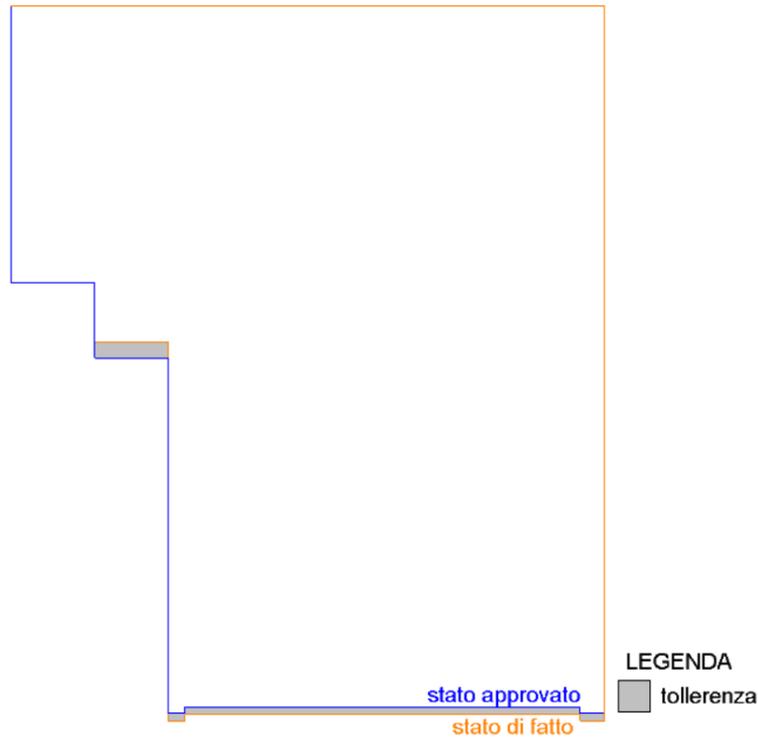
Comparazione superficie utile stato autorizzato – stato rilevato.
